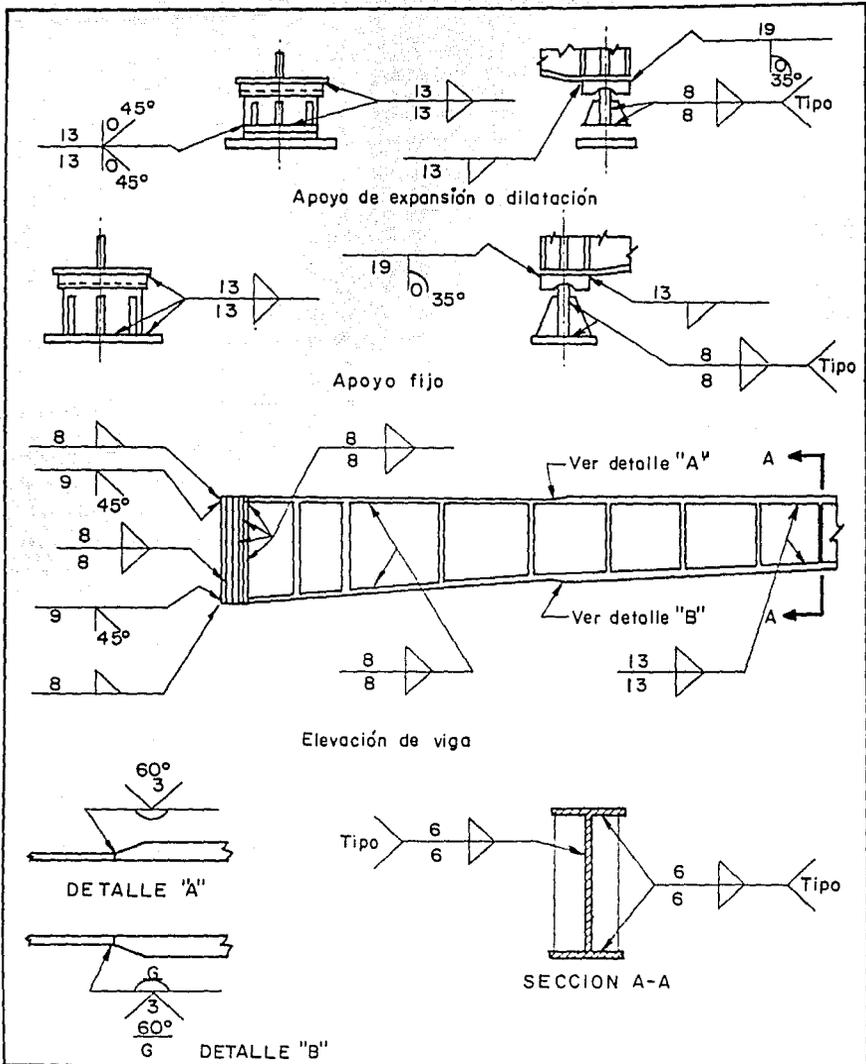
USO DE SIMBOLOS DE SOLDADURA EN DIBUJOS ESTRUCTURALES
